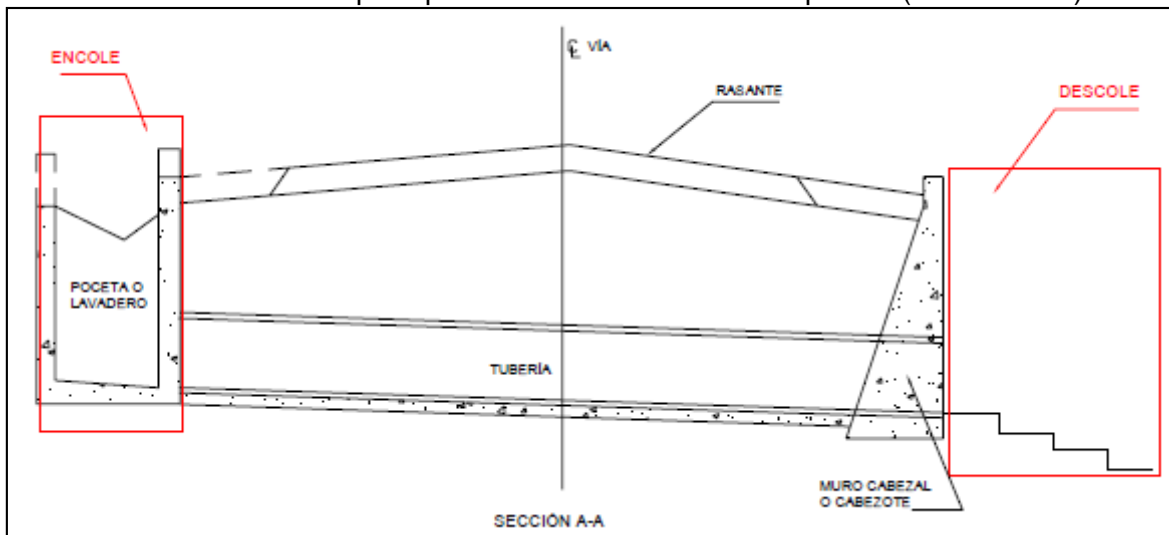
Partes principales de una alcantarilla con poceta (Planta).
